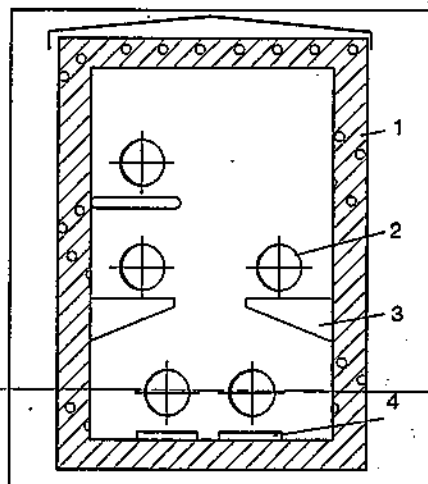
Canal circulabil din beton armat monolit:
